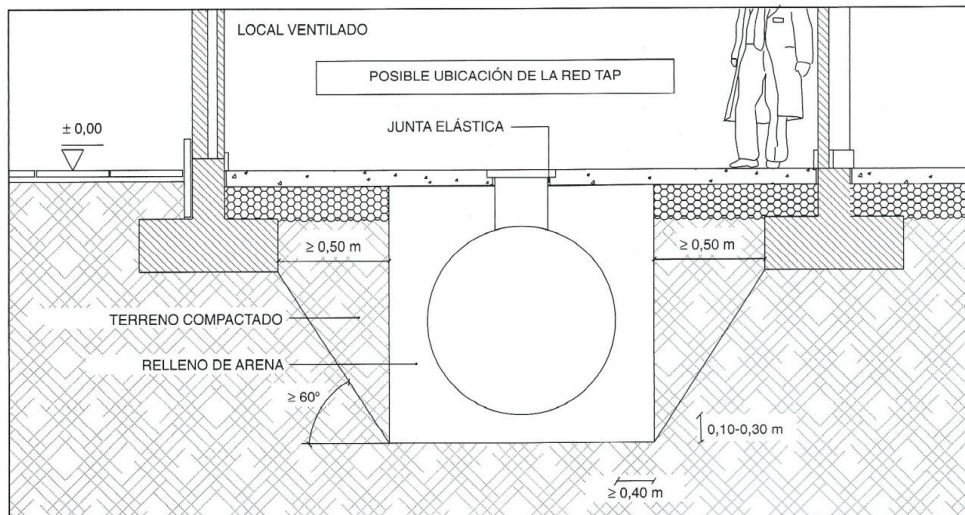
Ubicación bajo sótano o planta baja dentro del edificio.
